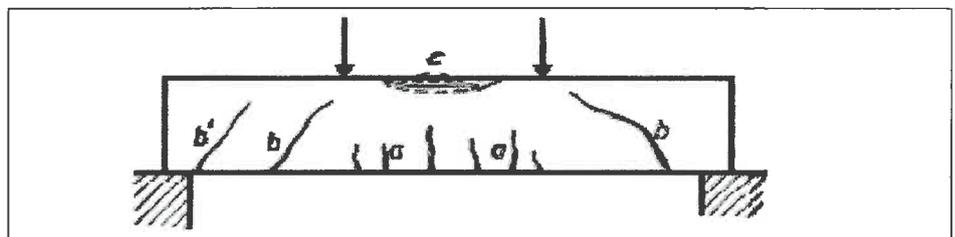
Grindă de beton armat și tipurile de fisuri ce pot apărea
